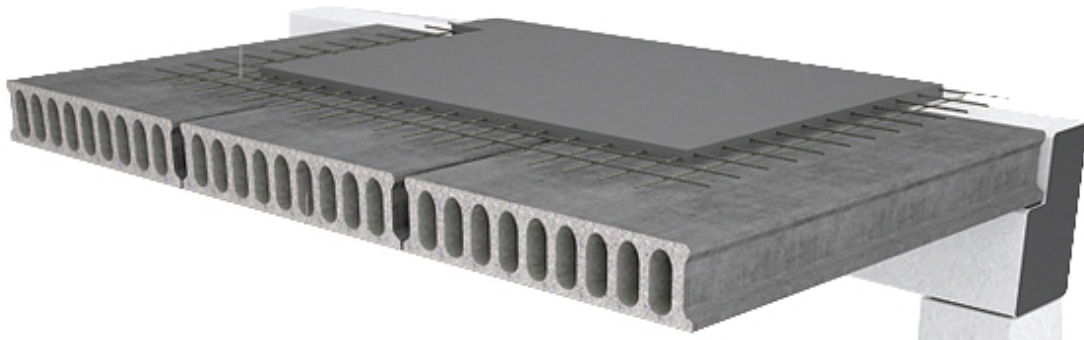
Detalle Forjado de losa alveolar (Fuente propia)
